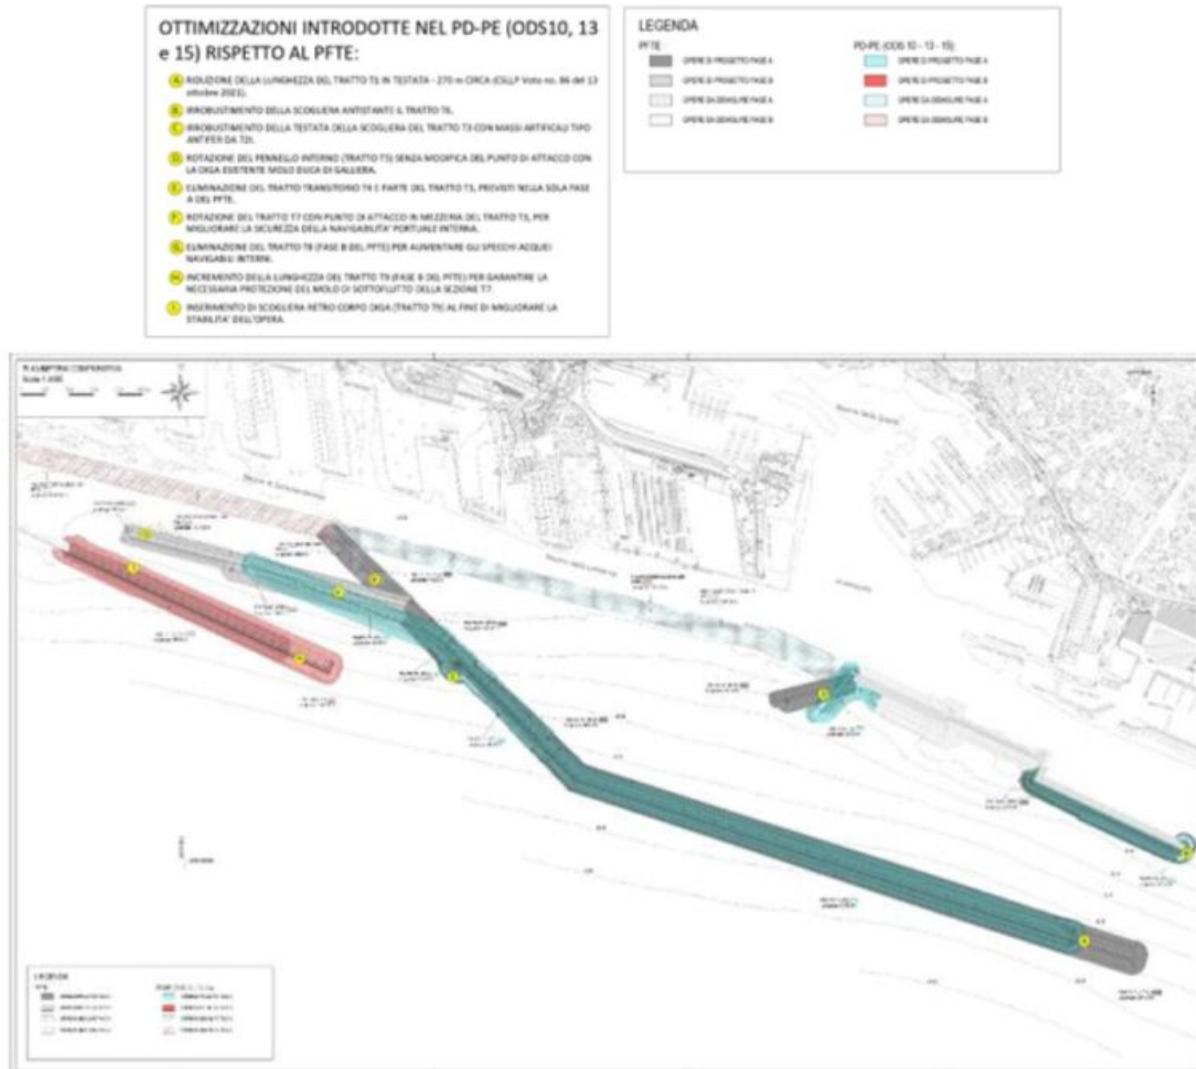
Planimetria generale comparativa Layout PTFE e Layout finale ultima variante
